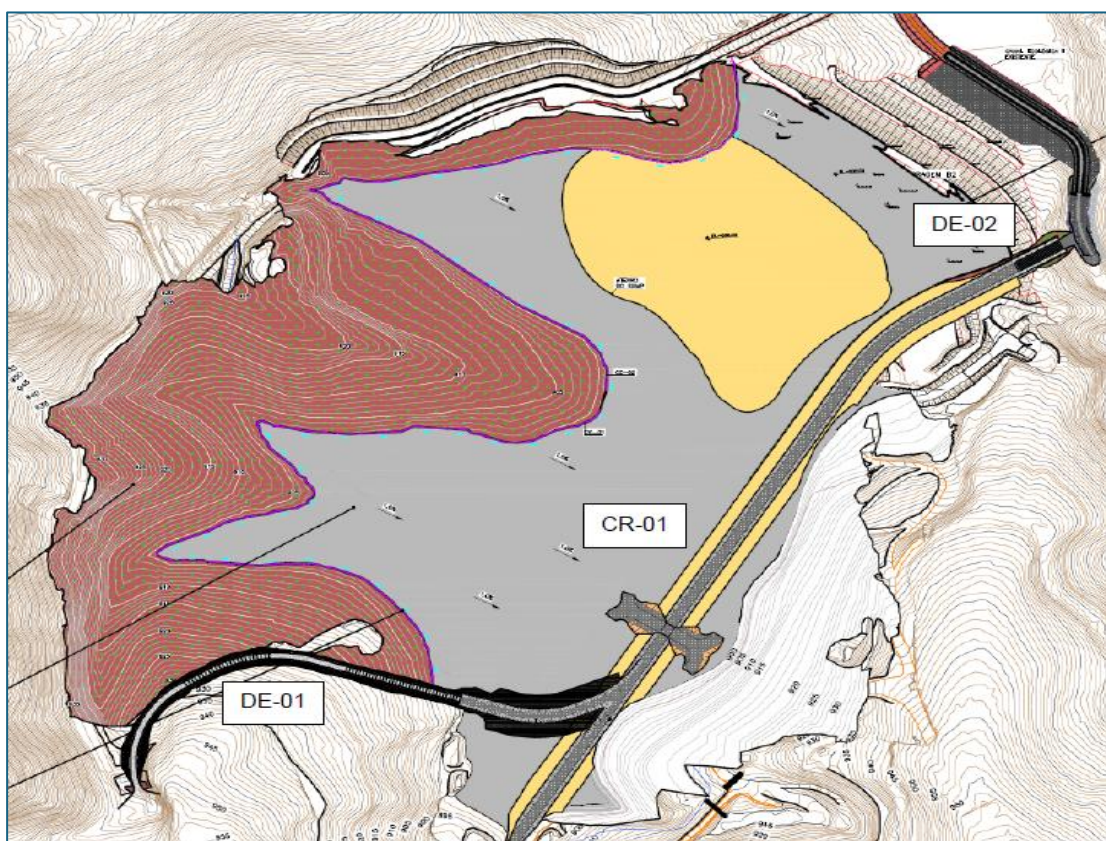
Arranjo das estruturas DE-01, CR-01 e DE-02 no sistema de drenagem da Barragem B2.
